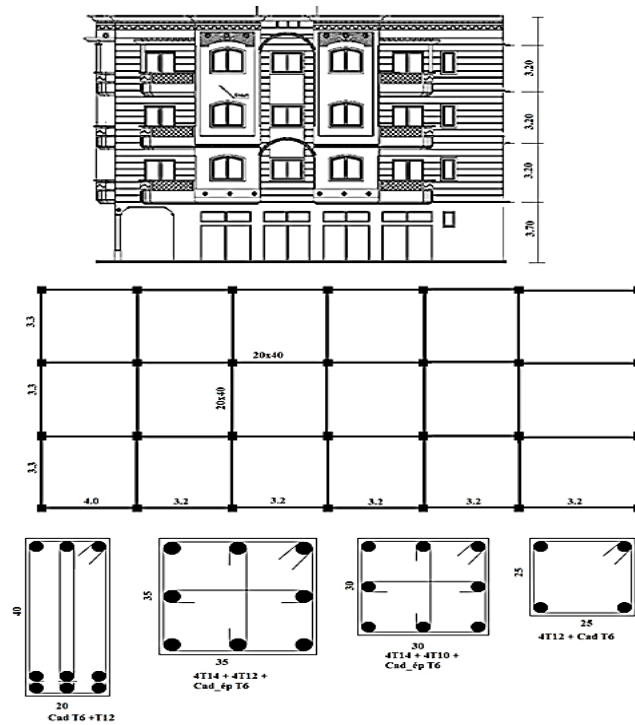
Plan, vues en élévation et détails du bâtiment de type C sélectionné.
